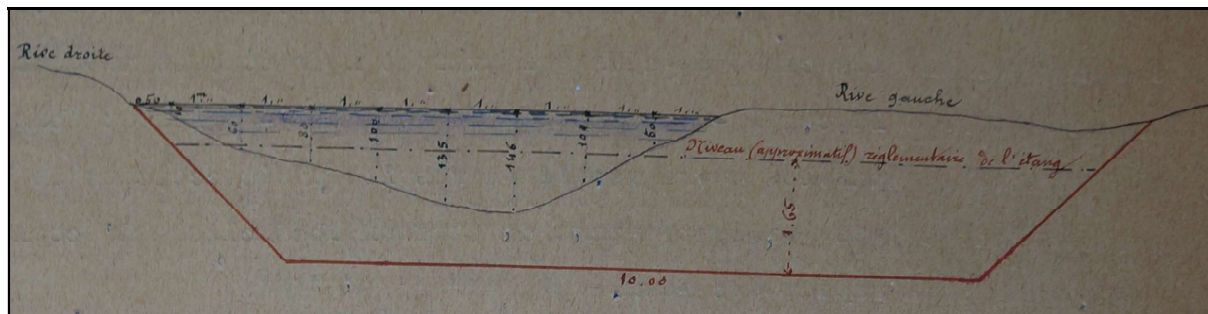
Profil en travers du canal montrant son ensablement (Source AD 33, SP 728).
